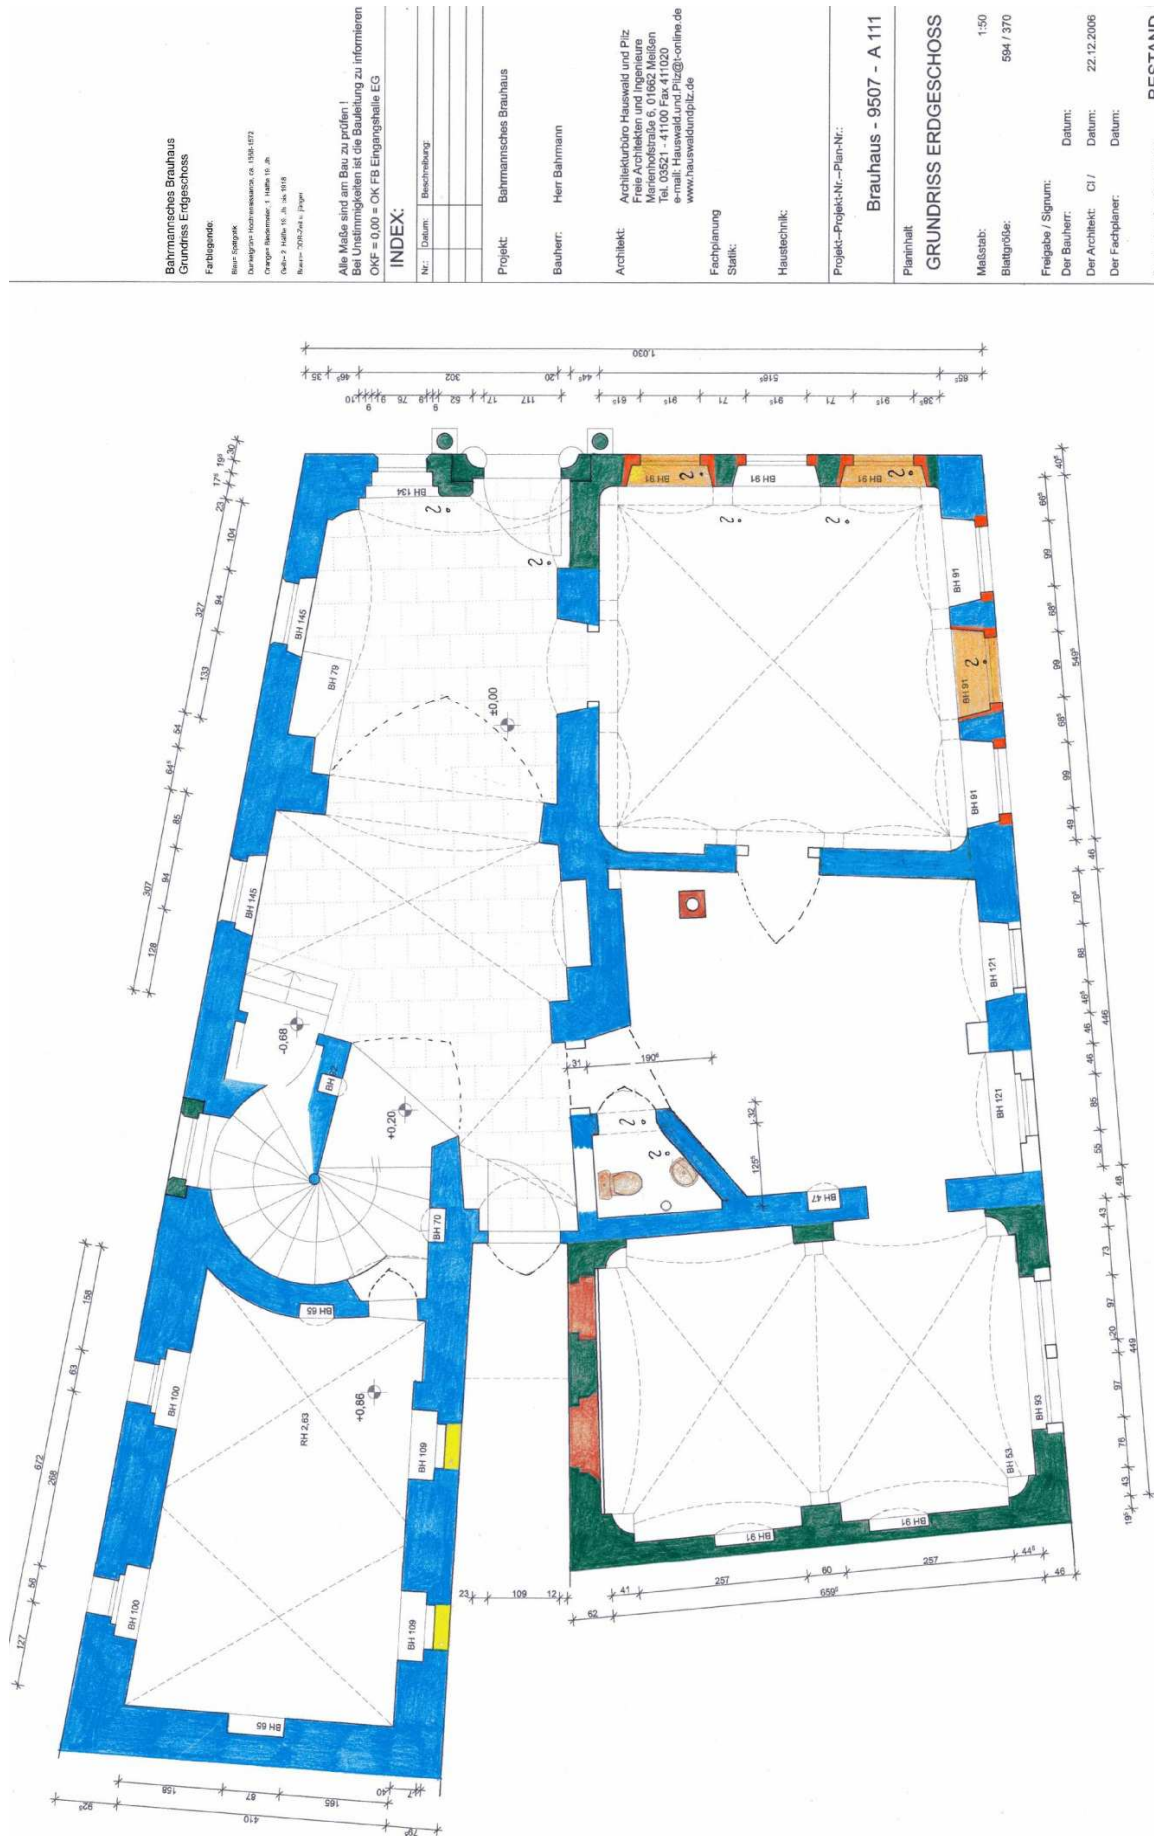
An der Frauenkirche 3, Baualtersplan Erdgeschoss
